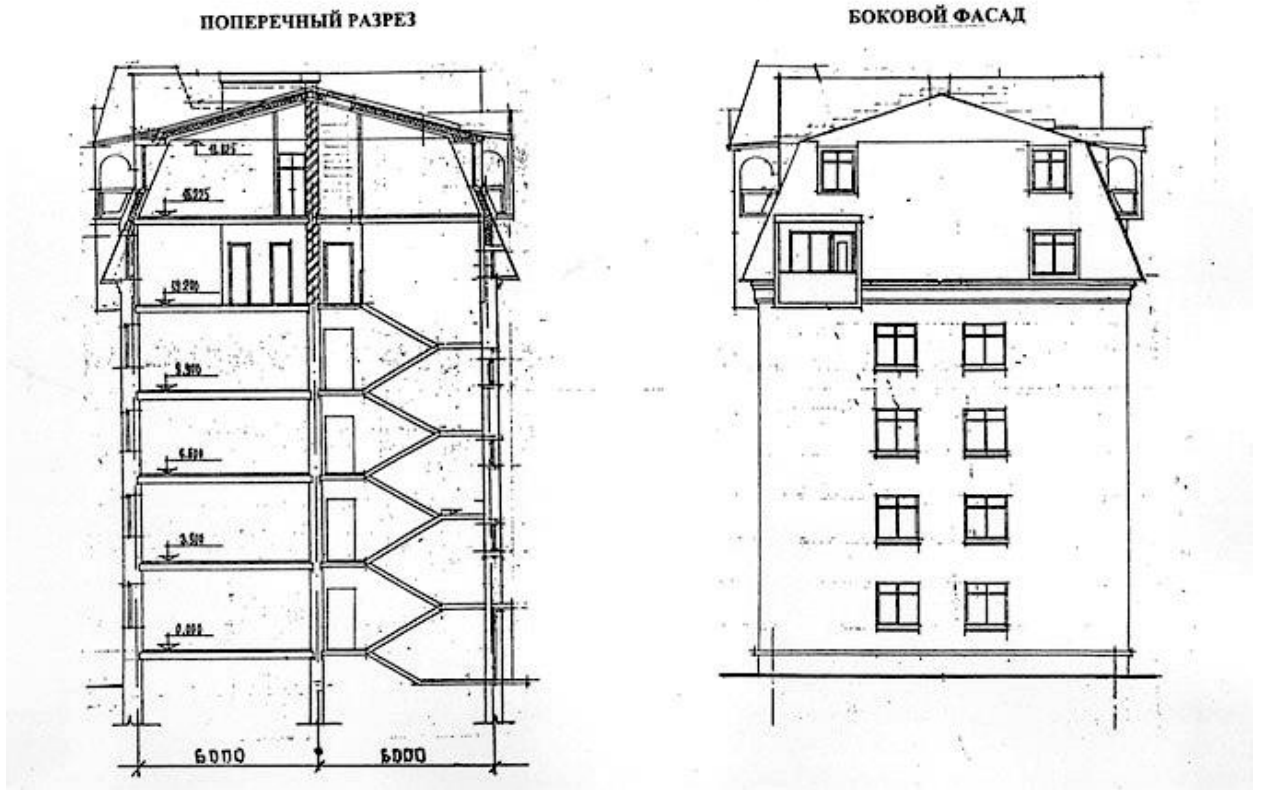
Устройство 2-уровневой мансарда с размещением 2-уровневых квартир при реконструкции 4-этажного жилого дома в г. Лыткарино. Поперечный разрез. Боковой фасад
